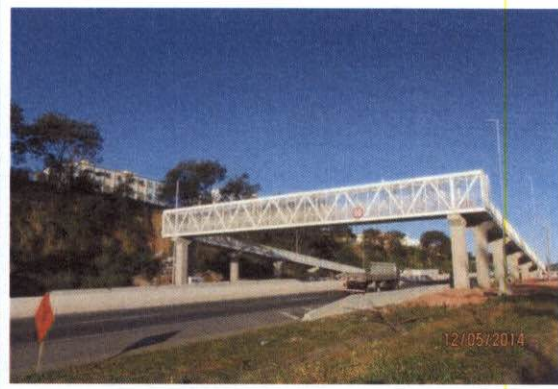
Vista geral da passarela instalada Km 271+800 em Serra.
